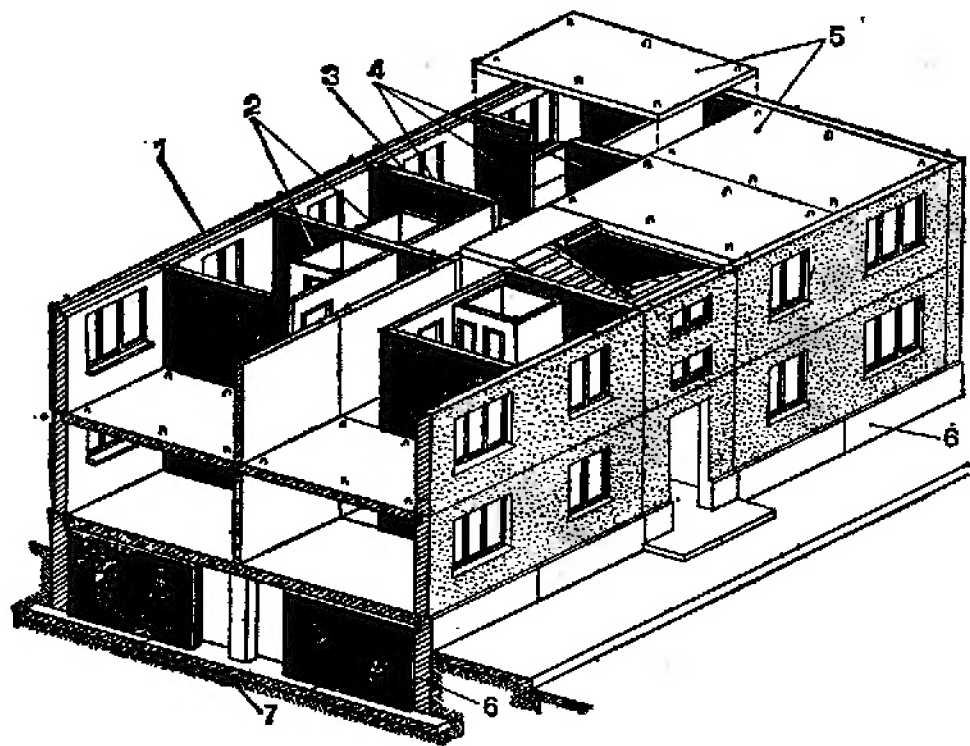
Конструктивная схема крупнопанельного дома с несущими стенами (перегородками):
